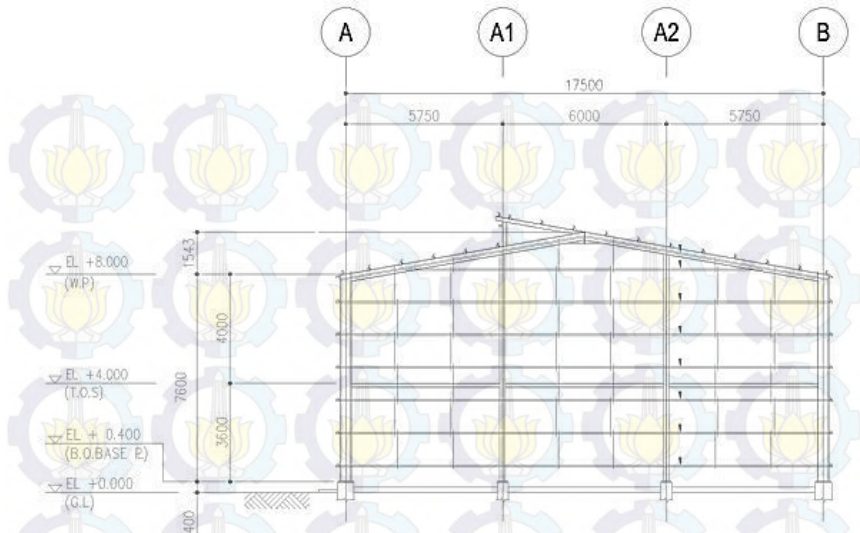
Tampak Potongan Rangka As-1 *Sistem Pre-Engineering Building
